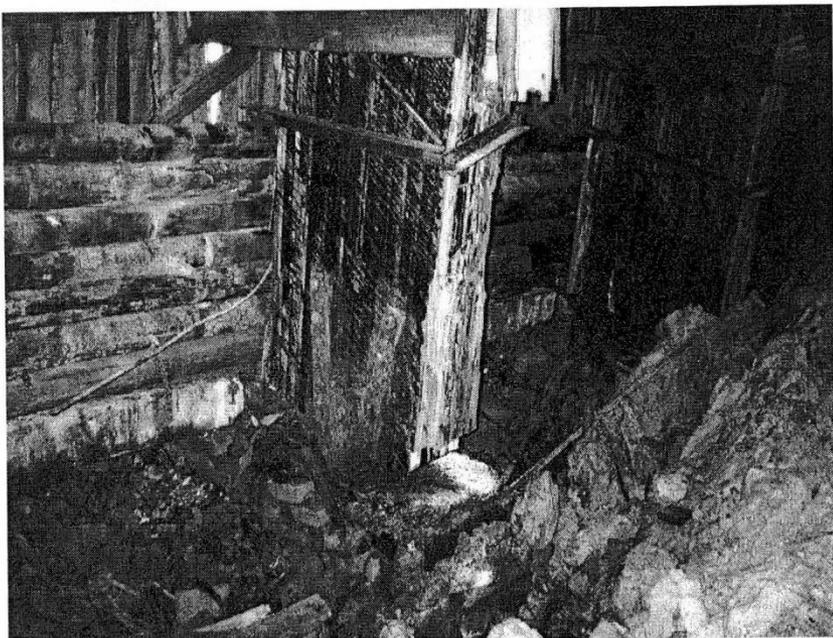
Механическое повреждение поперечного сечения клееной деревянной арки (отрыв четырех слоев на высоту 1,5 м от опорного узла)
